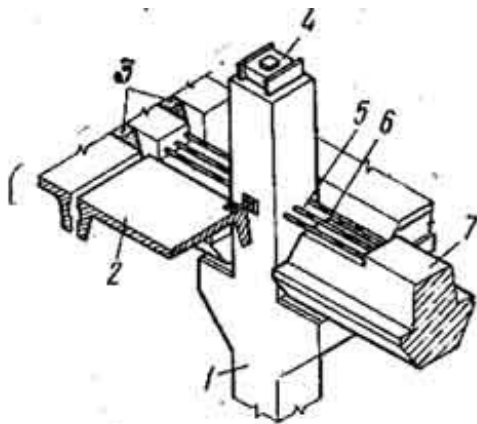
Узел балочного каркаса 1 - колонна; 2 - плиты перекрытия; 3 - бетон; 4 - стальной оголовок; 5 - выпуски арматуры; 6 - стыковые стержни; 7 - ригели
